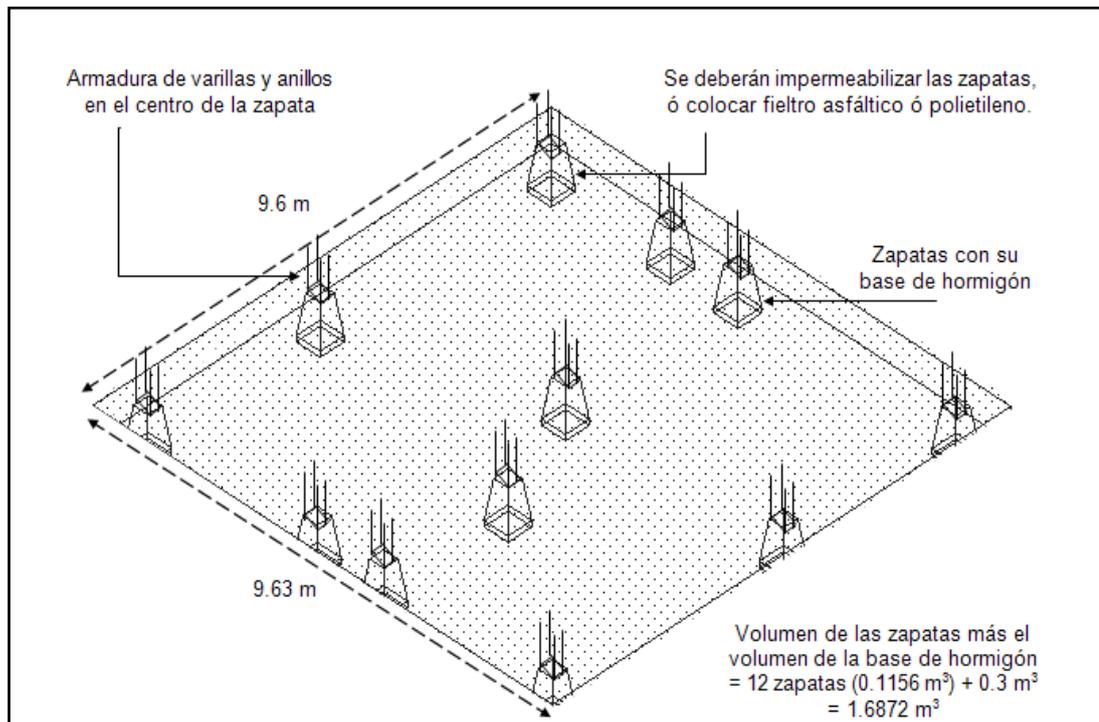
Colocación de las zapatas sobre las bases de concreto previo a la colocación de los materiales para la losa de cimentación.
